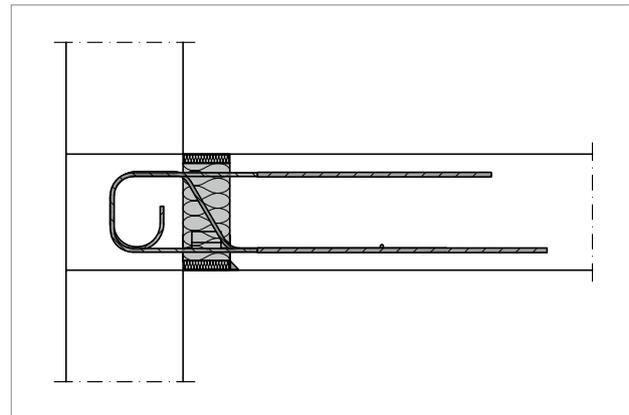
Schöck Rutherma® T type DFi : vue en coupe
